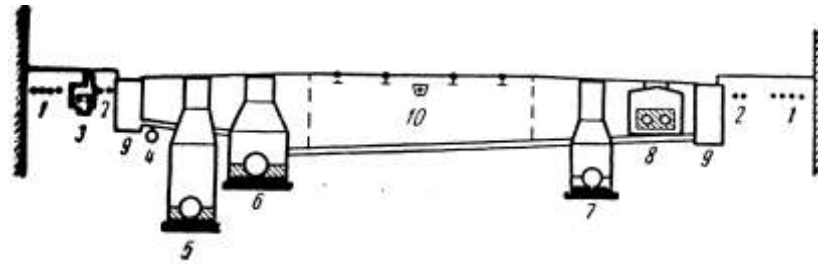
Поперечний перетин вулиці з підземними мережами
